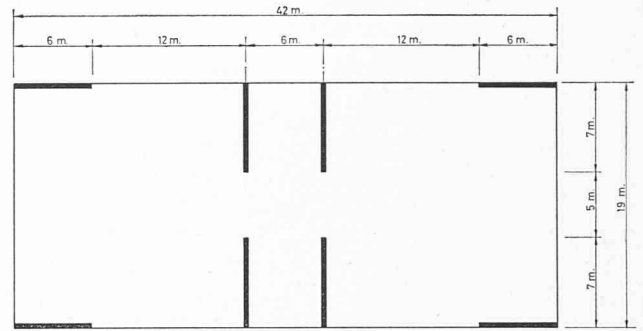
Structure plane : poutres-cloisons ou parois. Disposition en plan.
